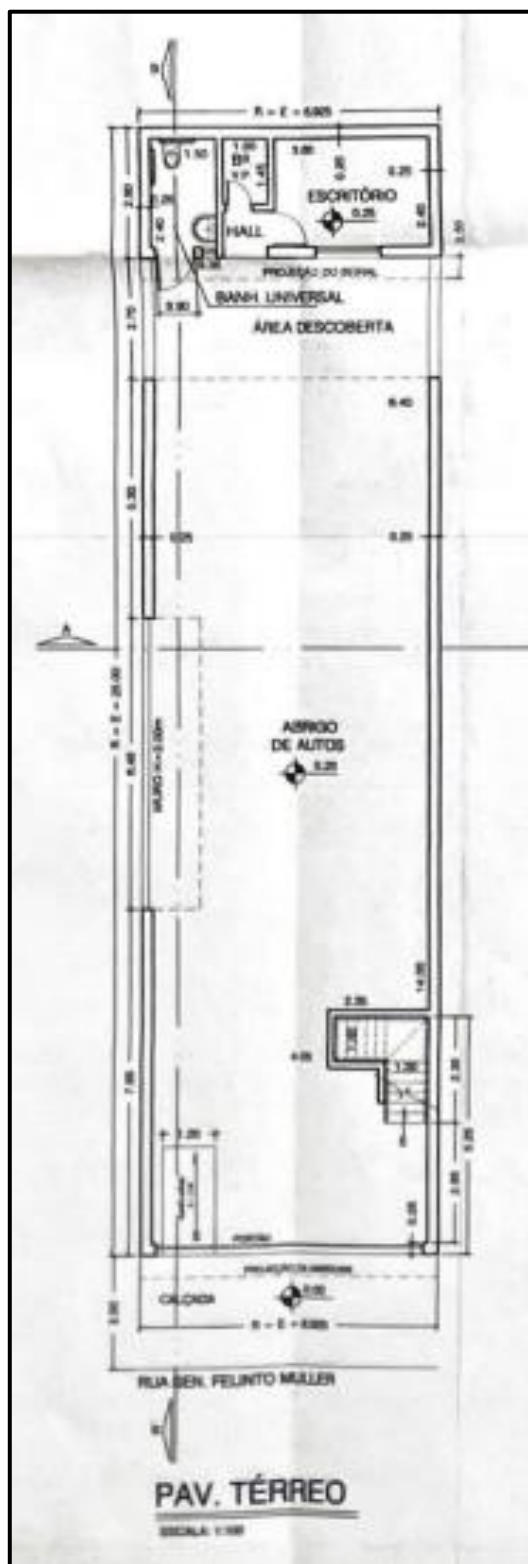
Pavimento térreo – Abrigo de autos (garagem de veículos)
